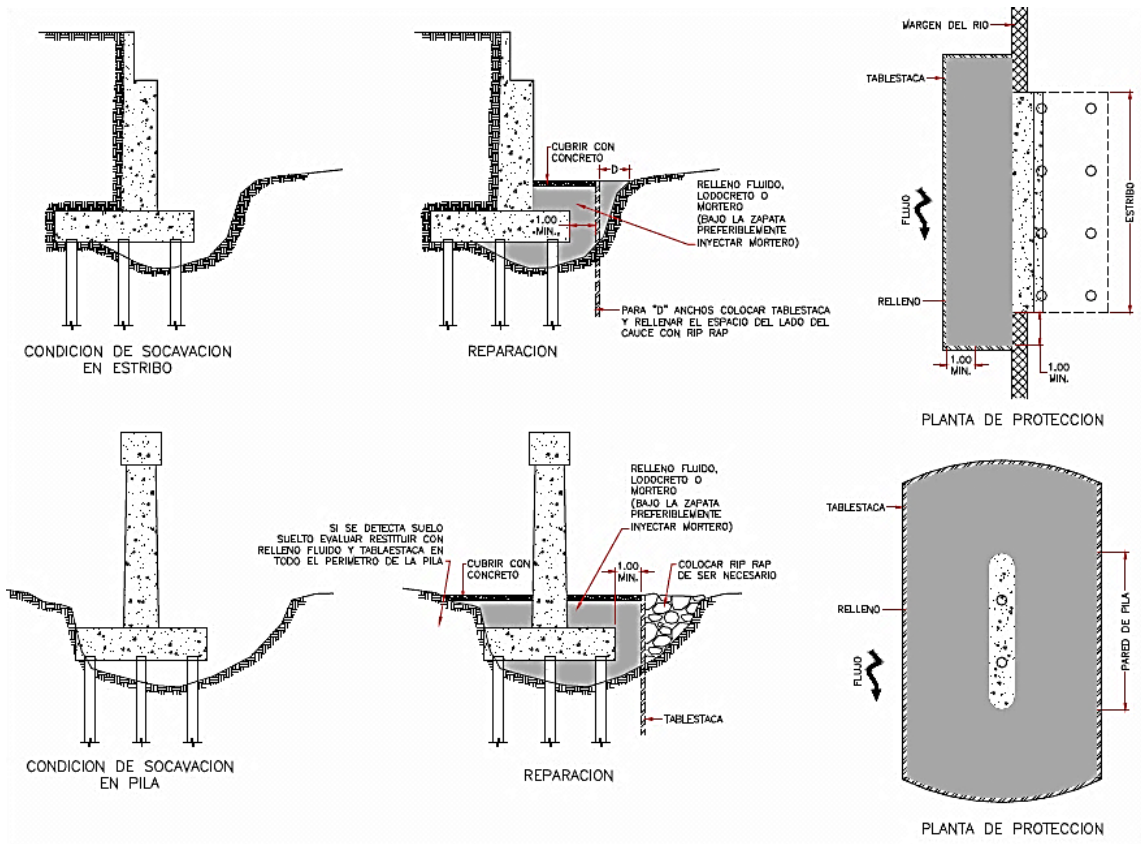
Propuesta de reparación en pilas y estribos de fundación con pilotes.
